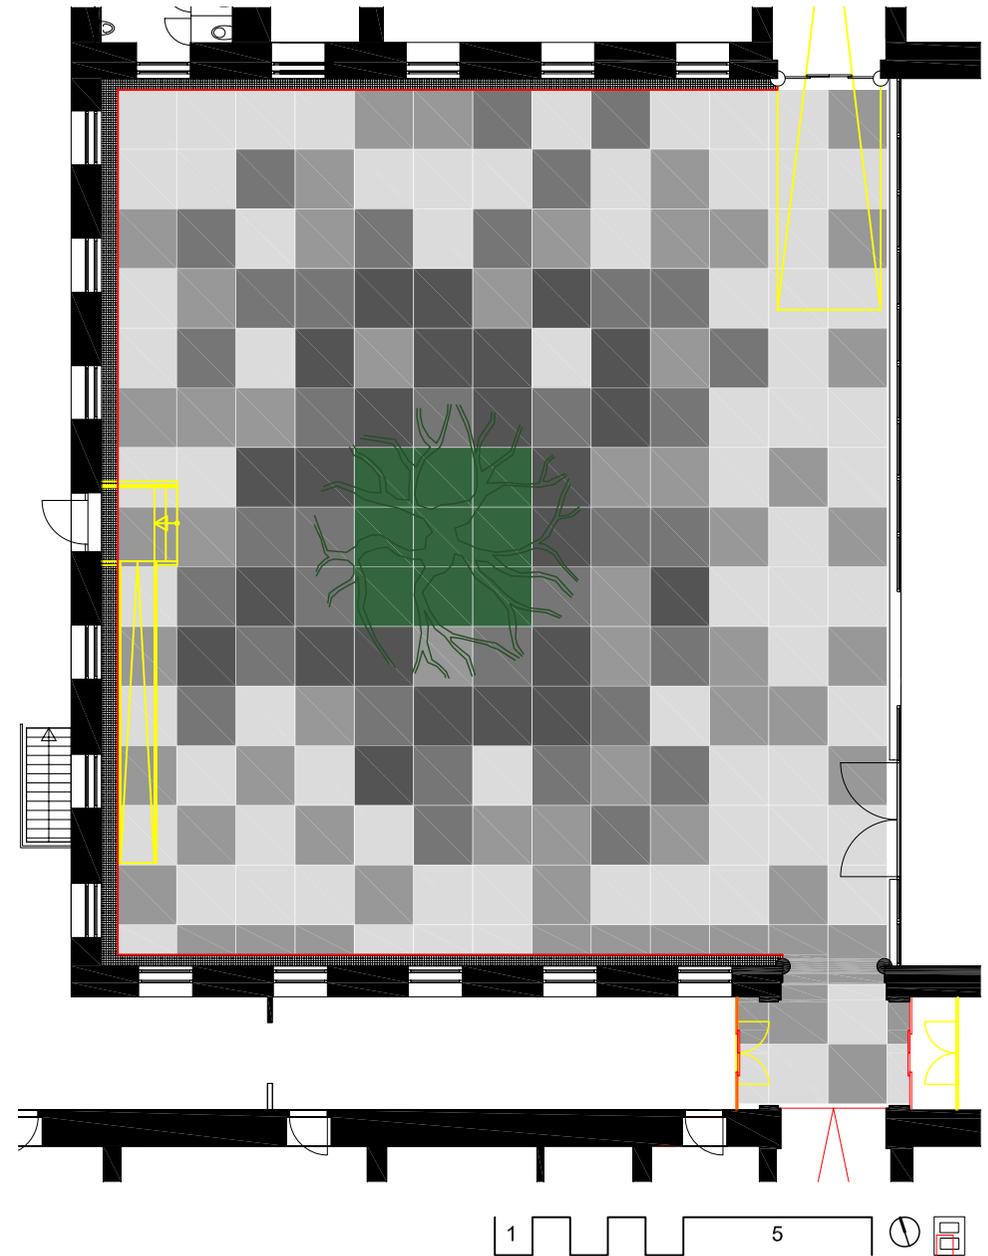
Innenhof mit neuem Bodenbelag und Abbruch der bestehenden Rampen ins Gebäude
